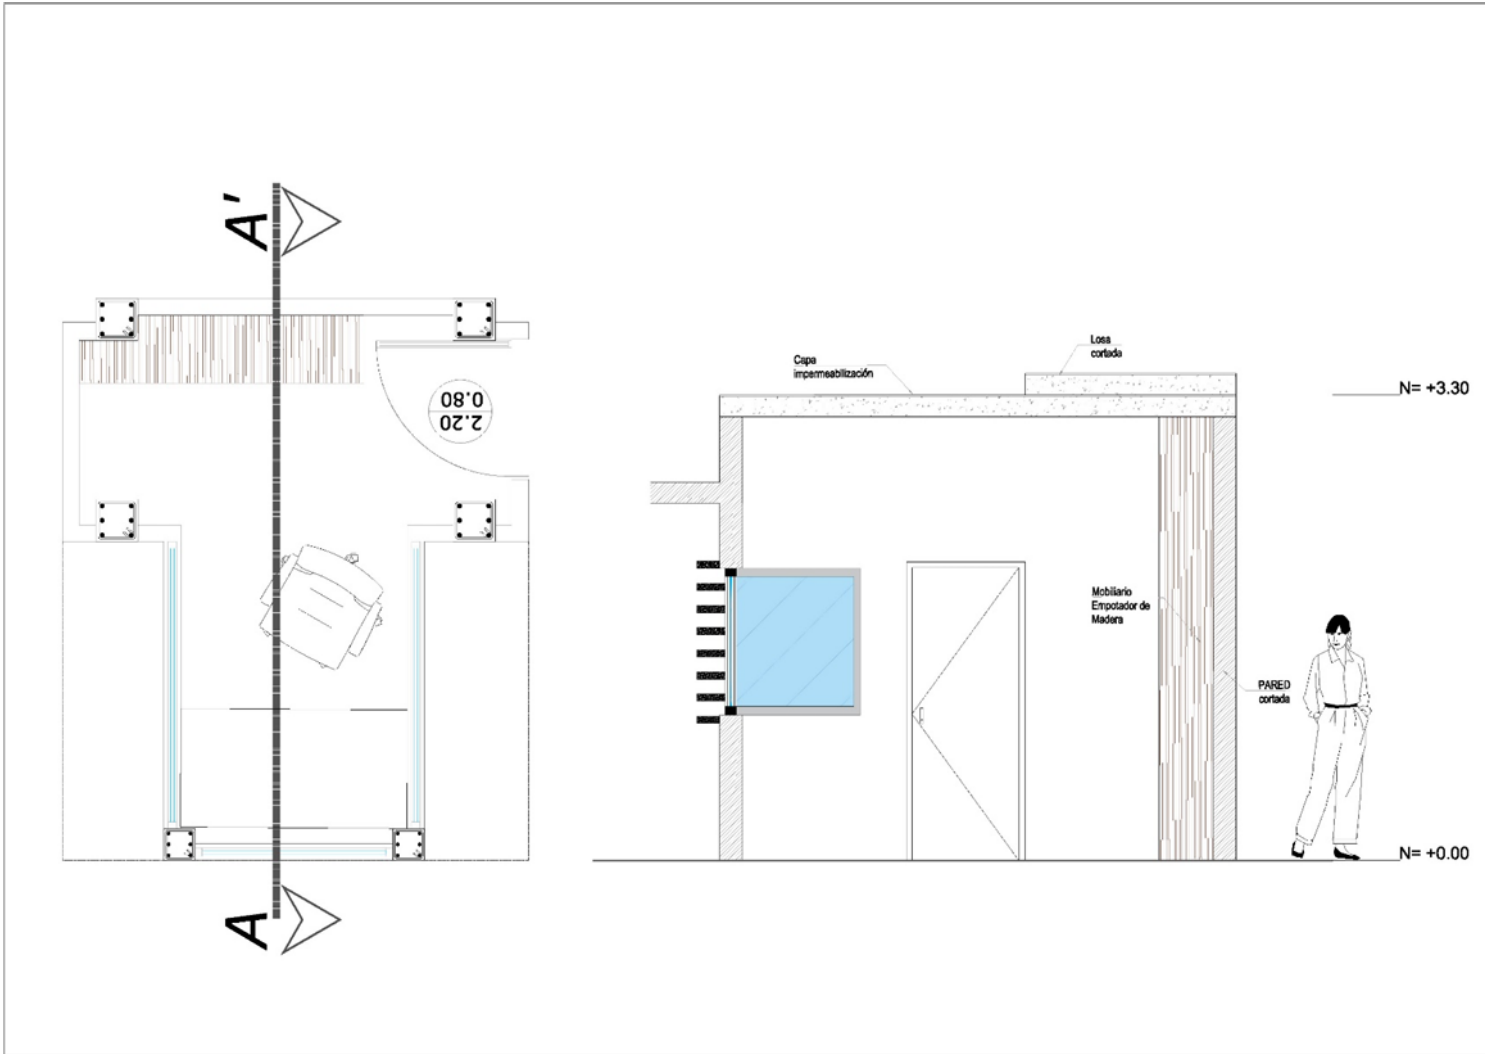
Detalle en Anexo 16. Elaboración: Propia.
